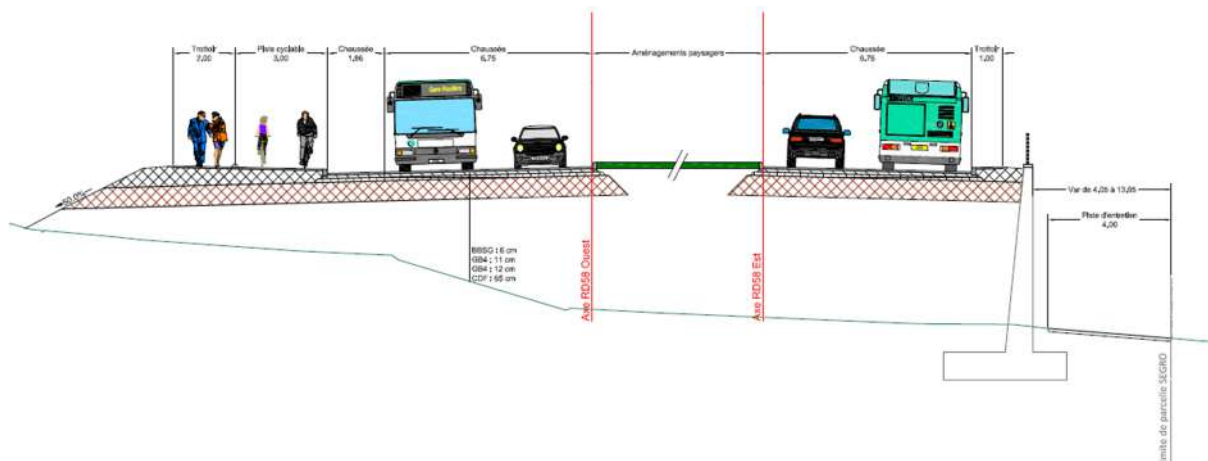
Profil en travers RD58 au droit du mur de soutènement
